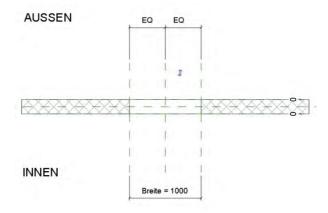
"M_Fenster" zur Erstellung einer ladbaren Fensterfamilie in Revit Architecture 2012. Dargestellt ist der Grundriss der im Familieneditor mit "Referenzebene" bezeichnet wird.
